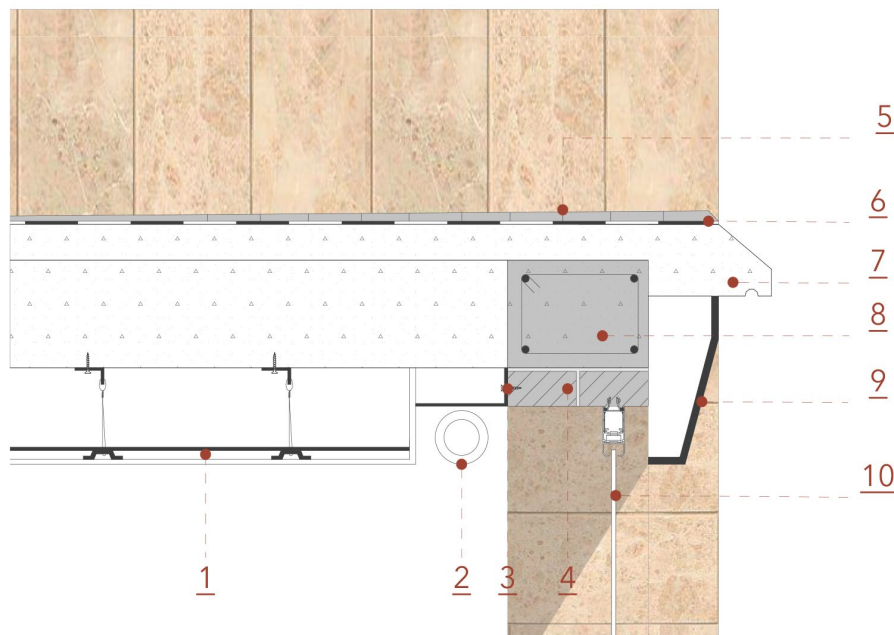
Detalle constructivo de remate superior en fachada reciclada. Gráficos de la autora.
